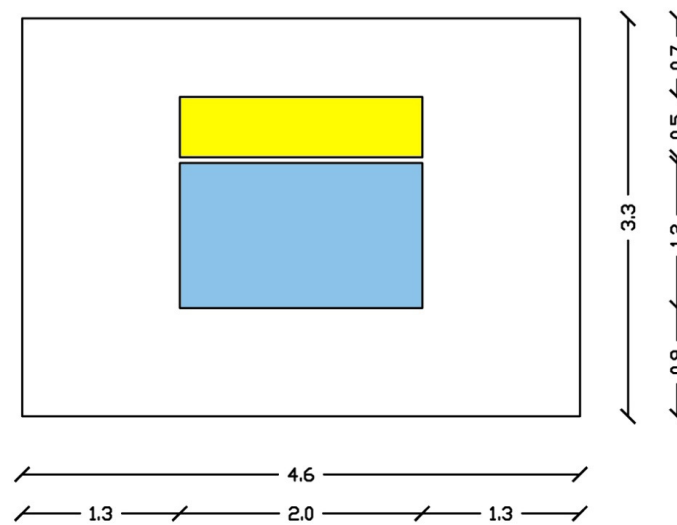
Prospetto Sud (Facciata principale) modello di studio
